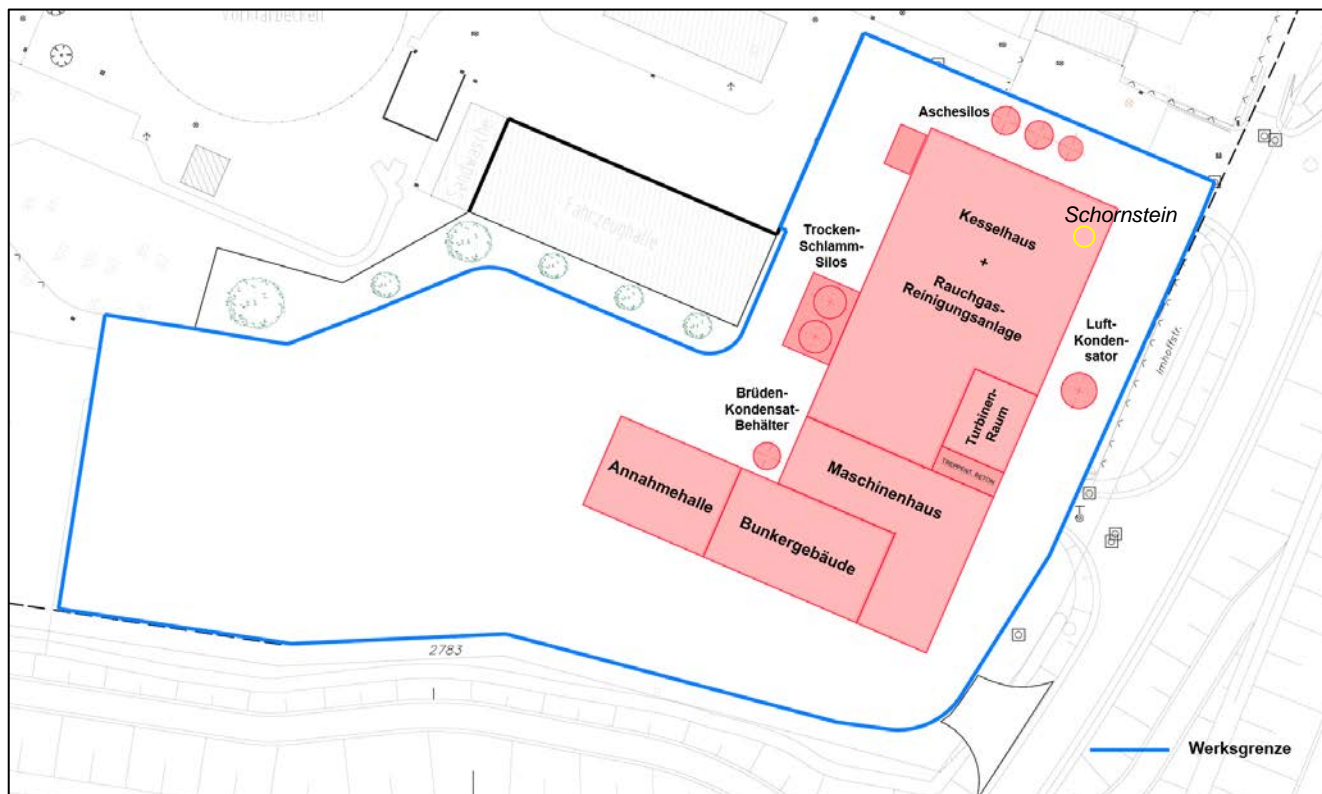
Lageplan und Werksgrenze der geplanten KVA
